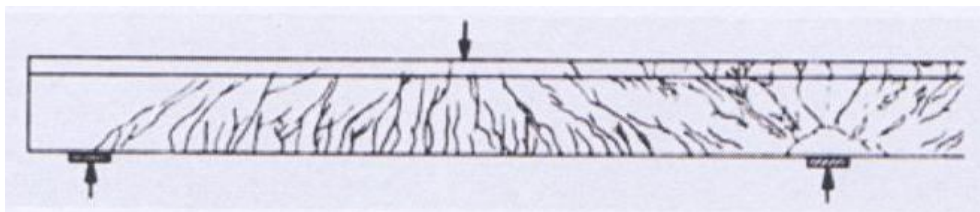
Fisuras típicas (extraída de Leonhardt [17]).
